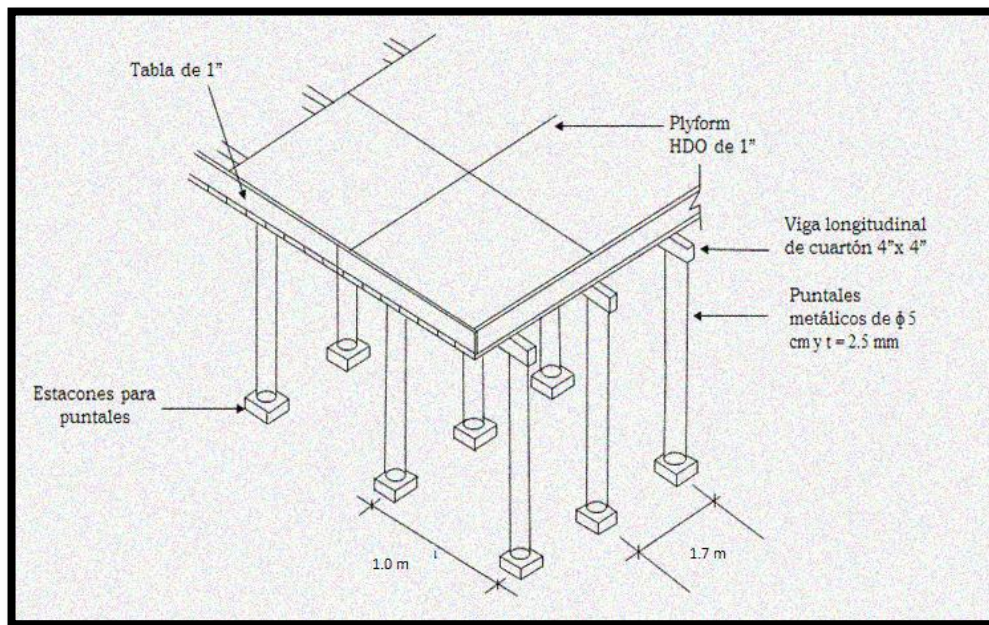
Diseño de encofrado mixto para losa densa (elaboración propia).
